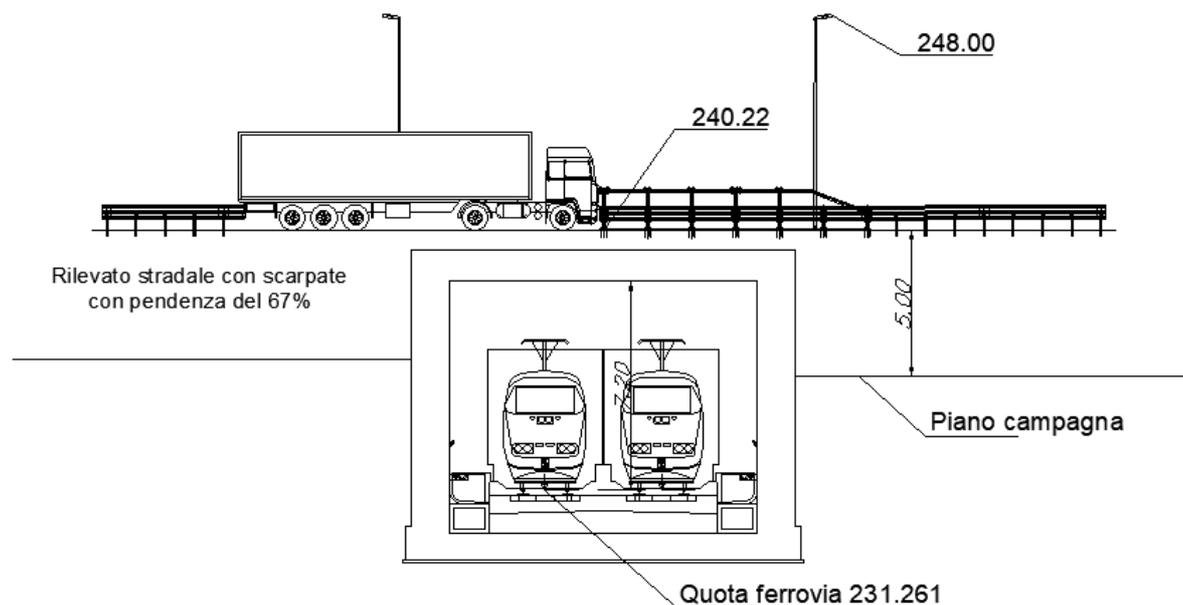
Sezione in corrispondenza cavalcaferrovia lungo strada di collegamento parcheggio P3 e centro commerciale Galassia
